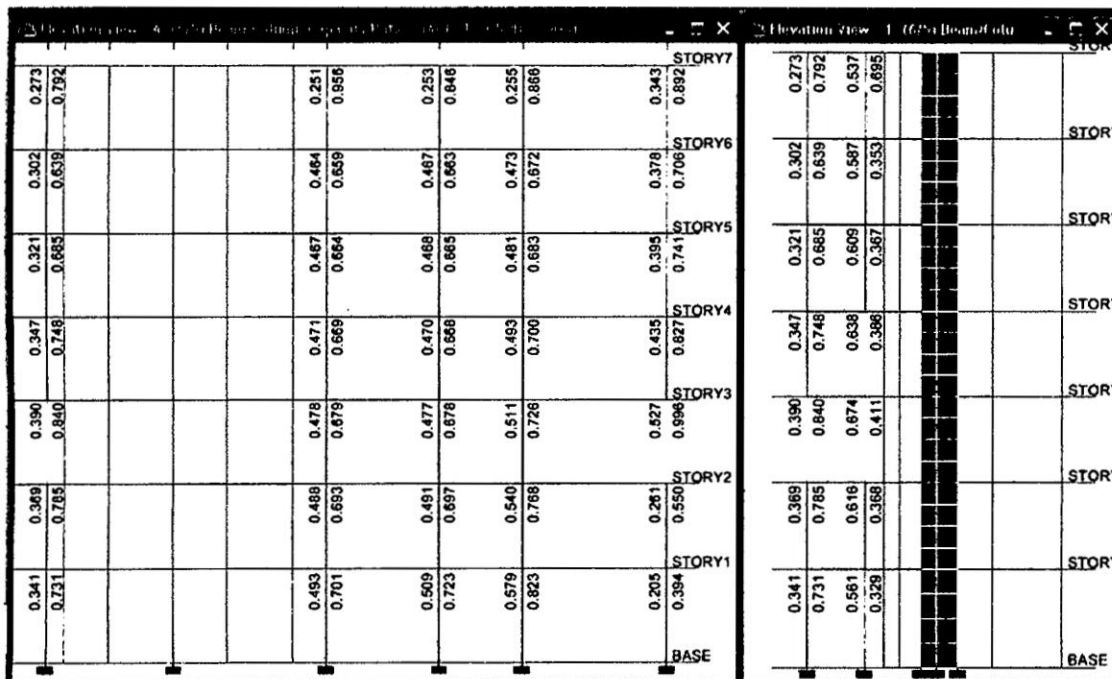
Revisión de columna fuerte viga débil con Etabs en el eje A-A y 1-1
